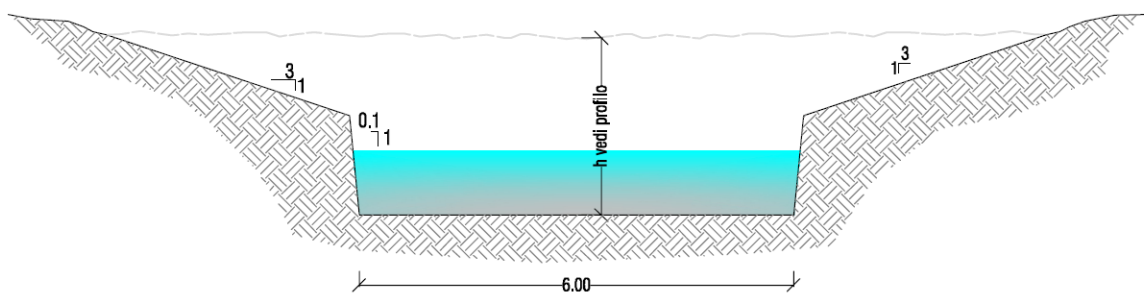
Sezione canale deviatore lama Scorbeto – primo tratto
